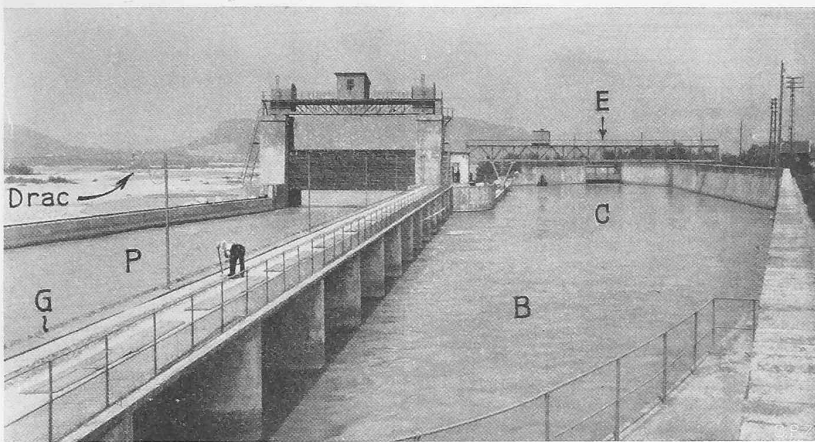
Wasserfassung des Kraftwerkes Pont-de-Claix am Drac. P Kiesgasse mit Stony-schütze, G Einlaufrechen, B Einlaufbecken, C Absetzbecken mit fahrbarem Bagger, E Kanaleinlauf.
